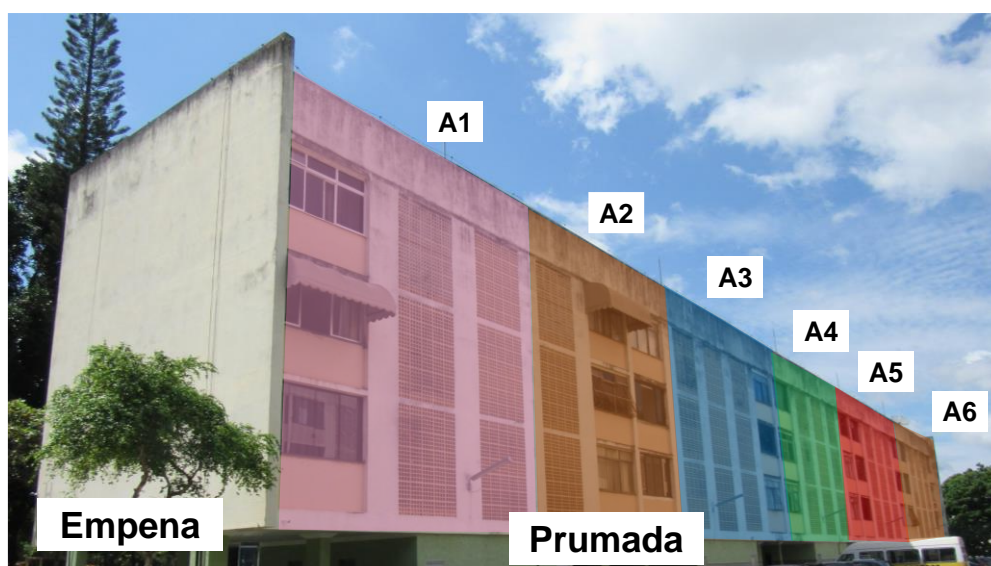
Tipos de elementos arquitetônicos e subdivisão da fachada em amostras.
